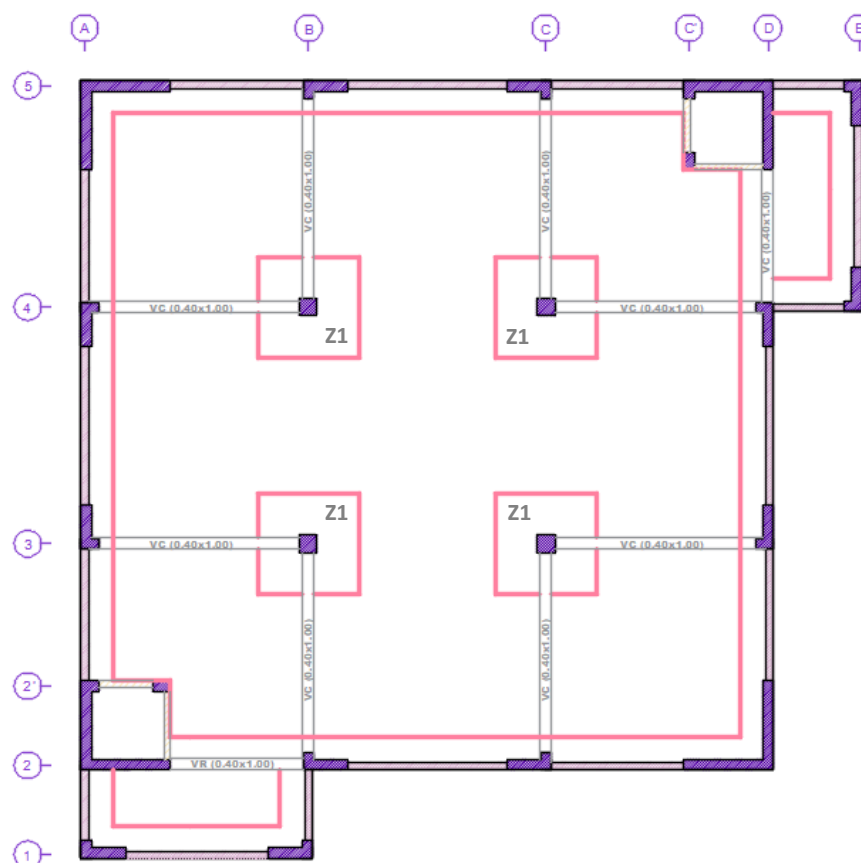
Cimentación continua unida a zapatas aisladas mediante vigas de conexión
